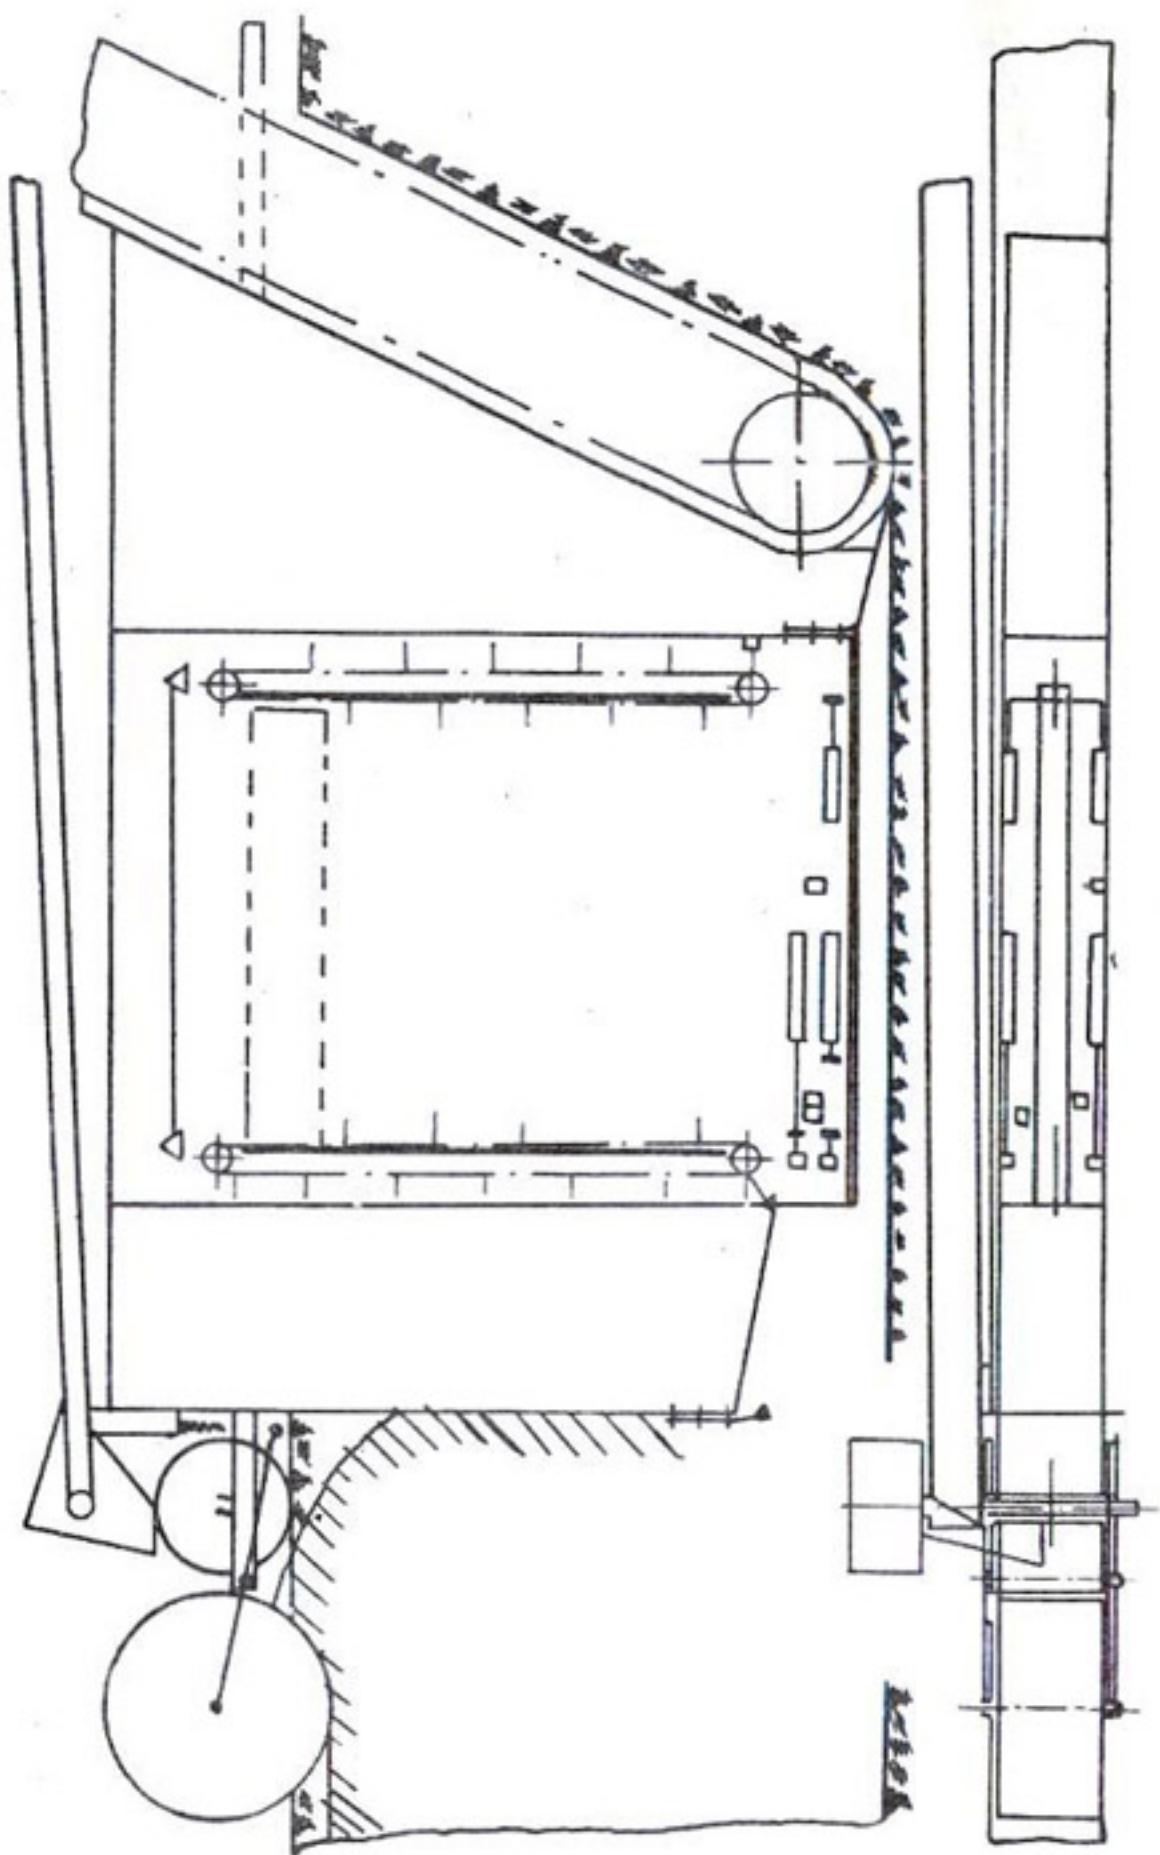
а, б. Дреноукладчик с гидромеханическим трубоукладыванием механизмом.
